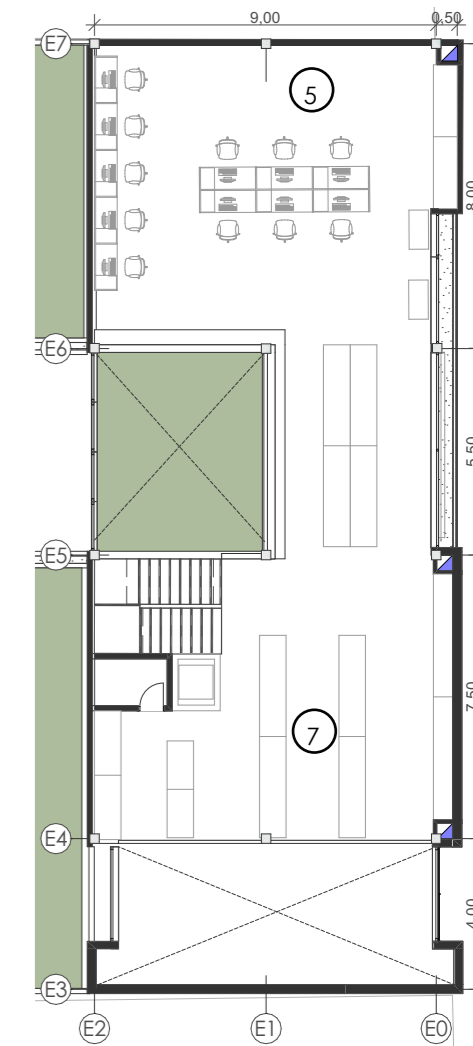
Segunda Planta Alta de la Biblioteca Elaboración propia (2026). Escala 1:200
